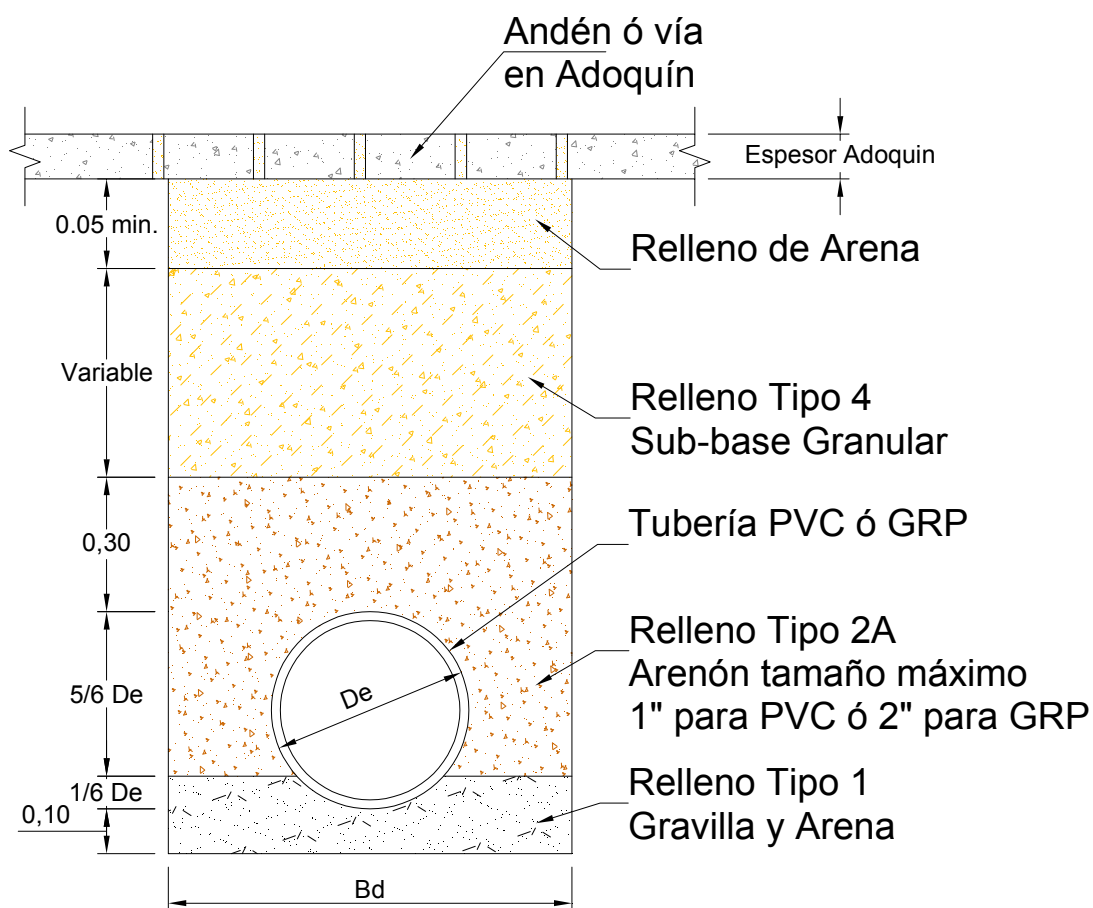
Cimentación Típica de tubería para Vías y Andenes en Adoquín
